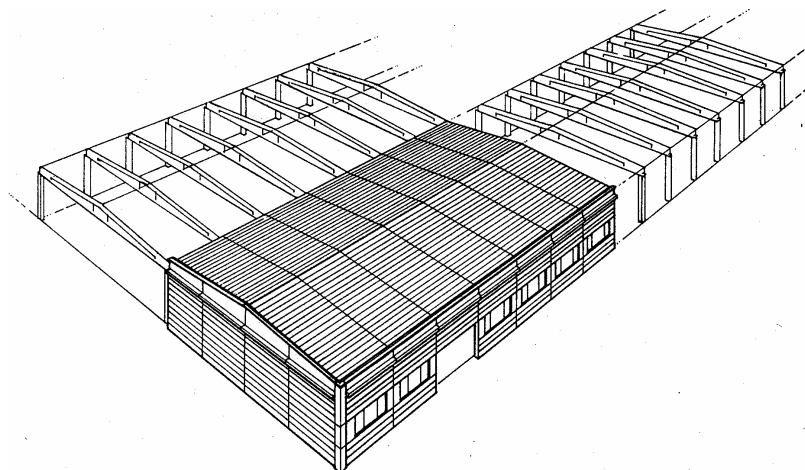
sistema de estrutura aporticada pré-moldada.
